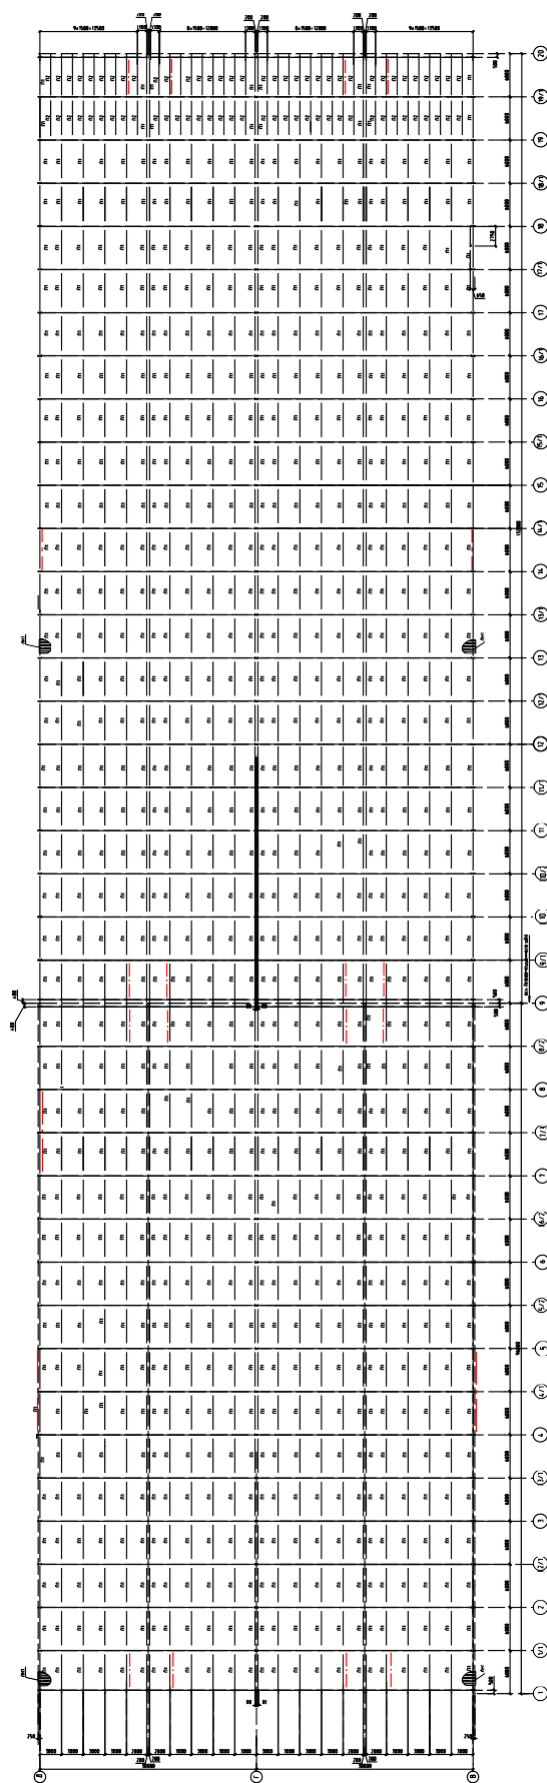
Схема розташування кроквяних ферм, прогонів покриття
